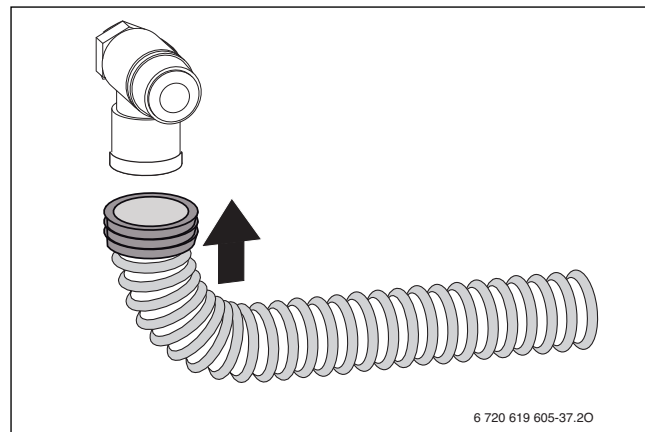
Montaggio del tubo flessibile sulla valvola di sicurezza
